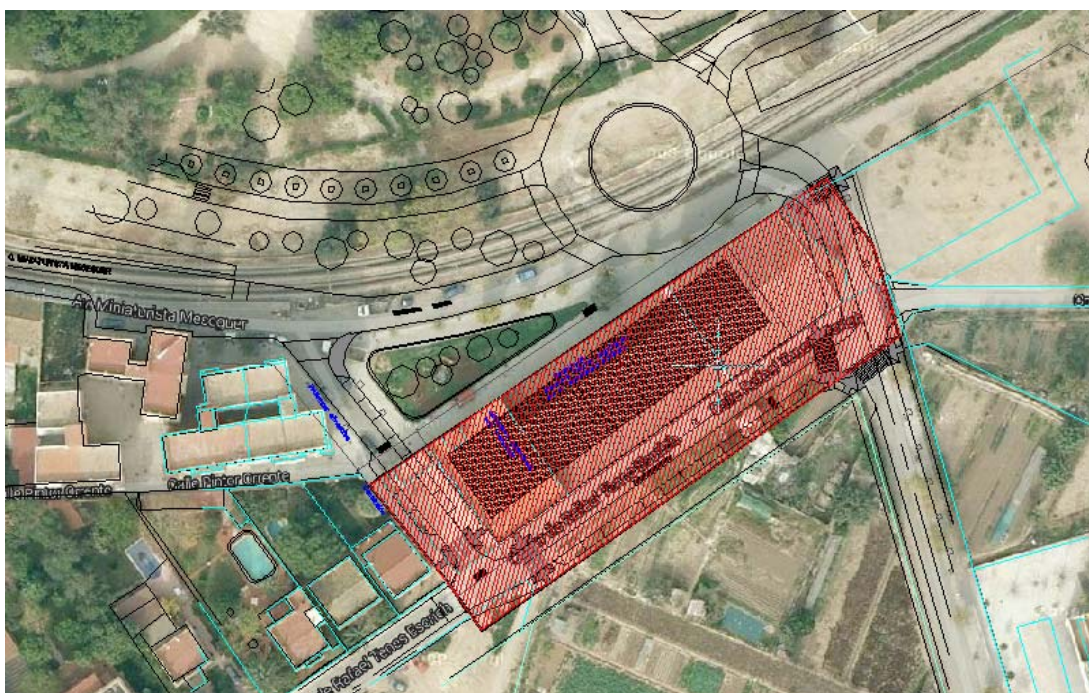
MONTAJE CON LA VISTA AÉREA DE LA ZONA DE ACTUACIÓN.
